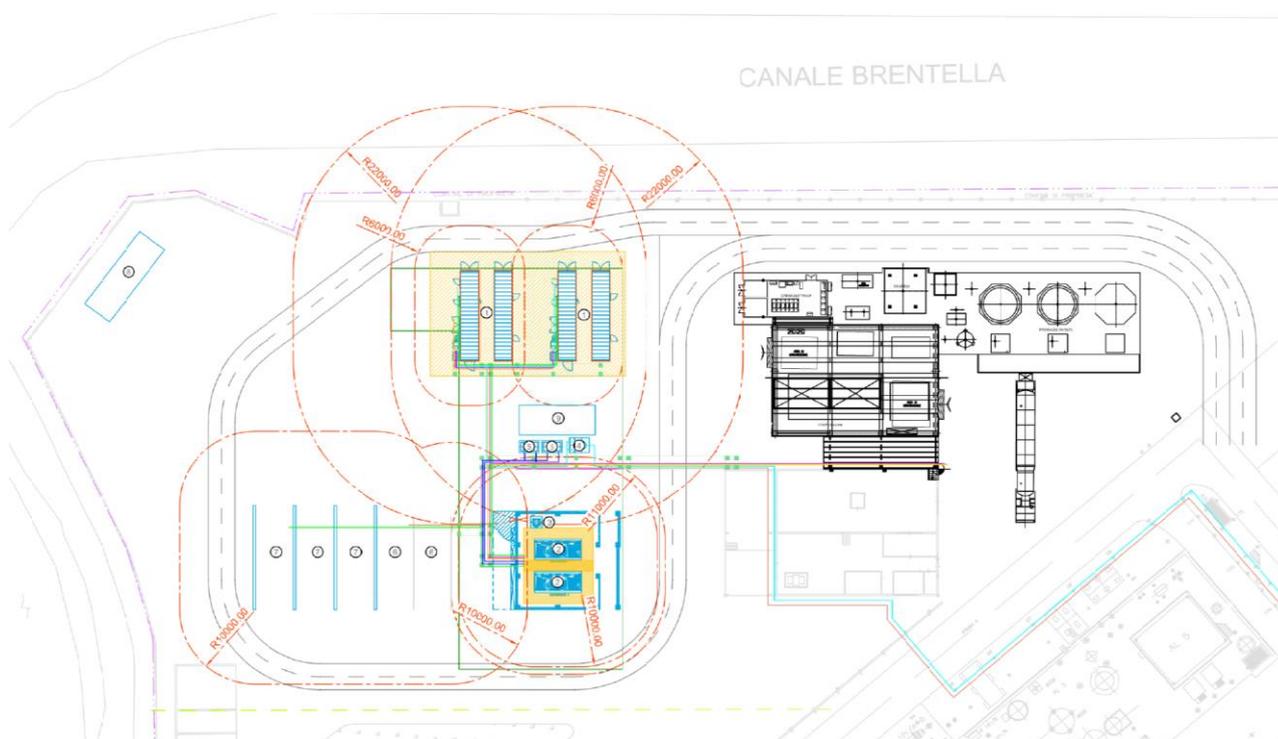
Rappresentazione in pianta dell'Impianto di Produzione
